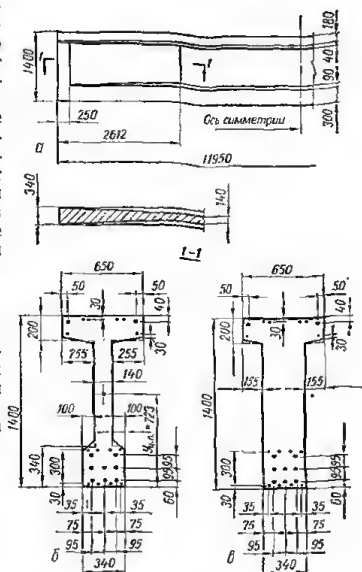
Опалубочные размеры балки и поперечные сечения балки с расположением арматуры:
